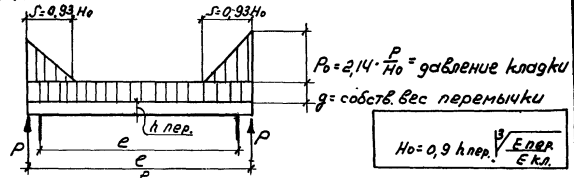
Схема нагрузок на перемычку при расчете по случаю «д»
